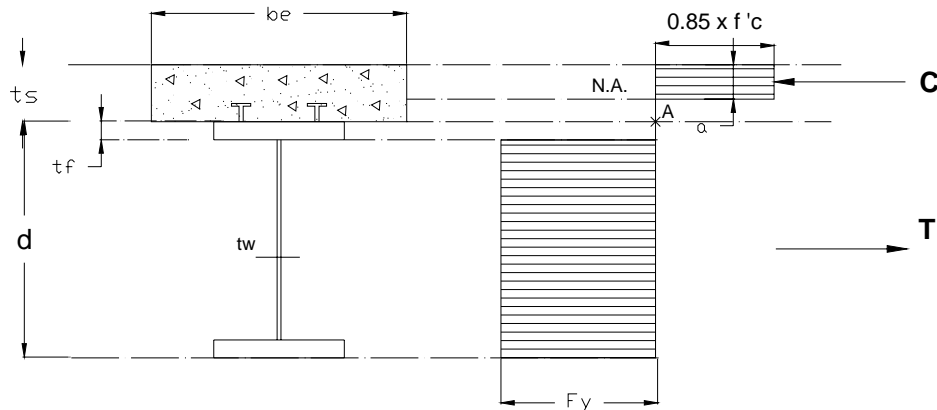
Distribución plástica de esfuerzos en una trabe de sección compuesta. Primera hipótesis, el eje neutro (N.A.) se encuentra en la losa de concreto.
